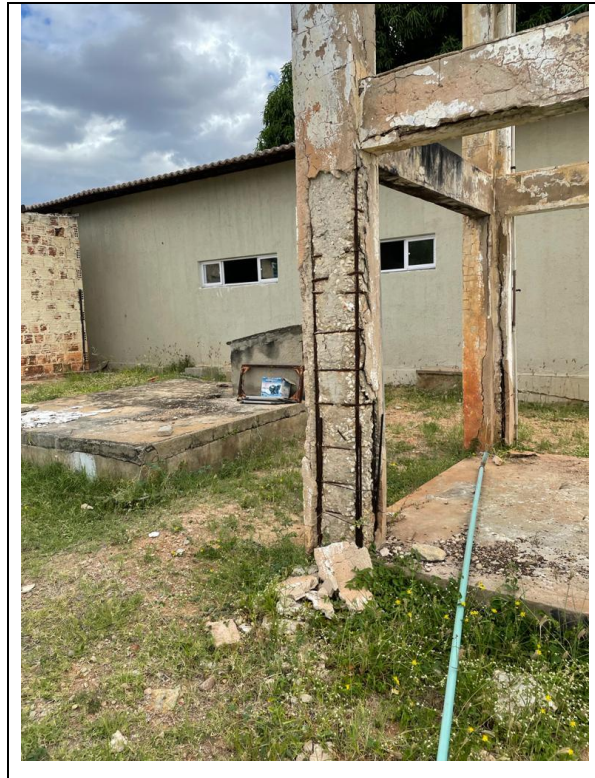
Corrosão de armadura e deslocamento de concreto nos pilares e vigas do Reservatório.
